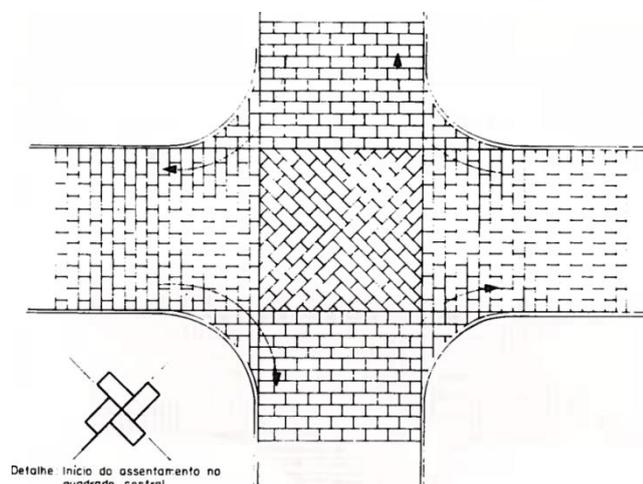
Assentamento normal de pavimentação em paralelepípedo
